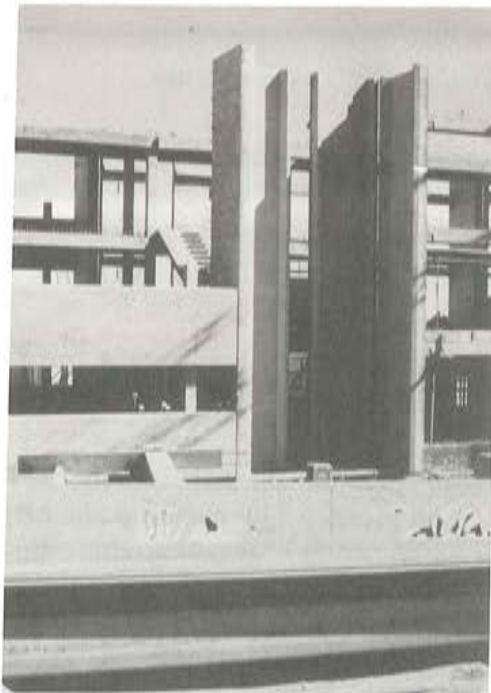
Módulos de fachada, Pantallas y Escaleras.
